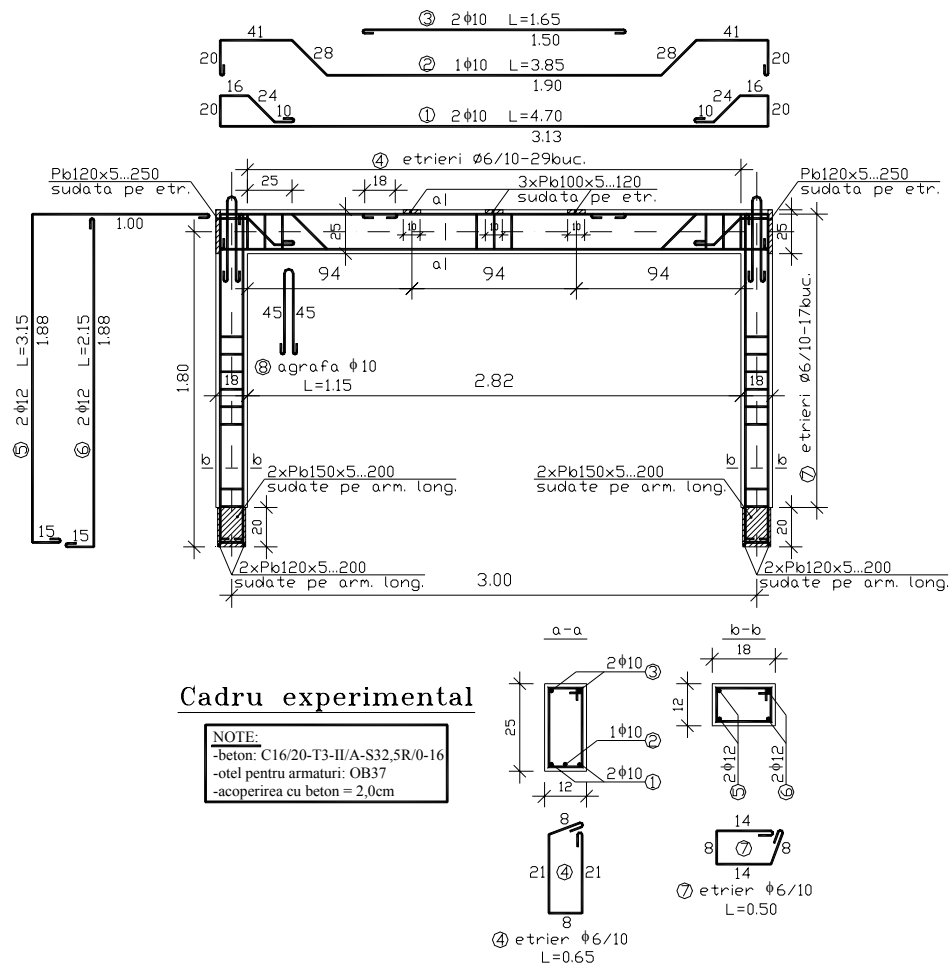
Detalii de alcătuire a cadrelor din beton armat.
